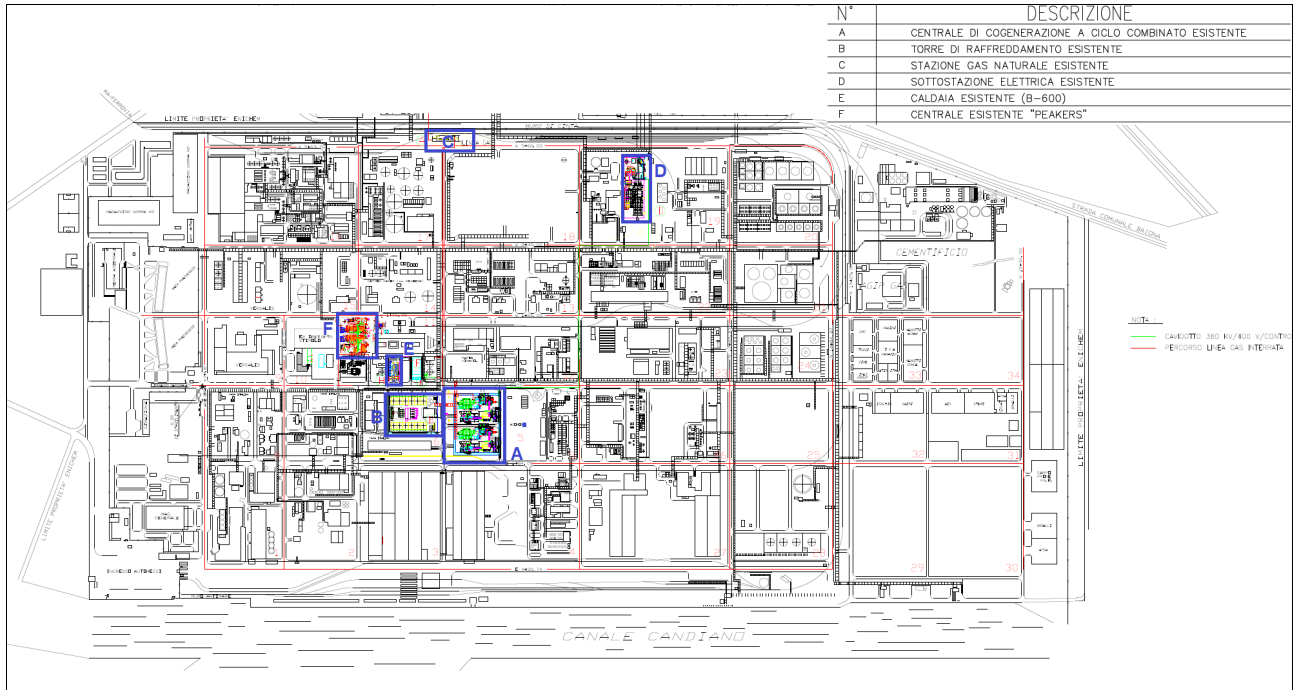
4 planimetria di sito con ubicazione degli impianti Enipower
